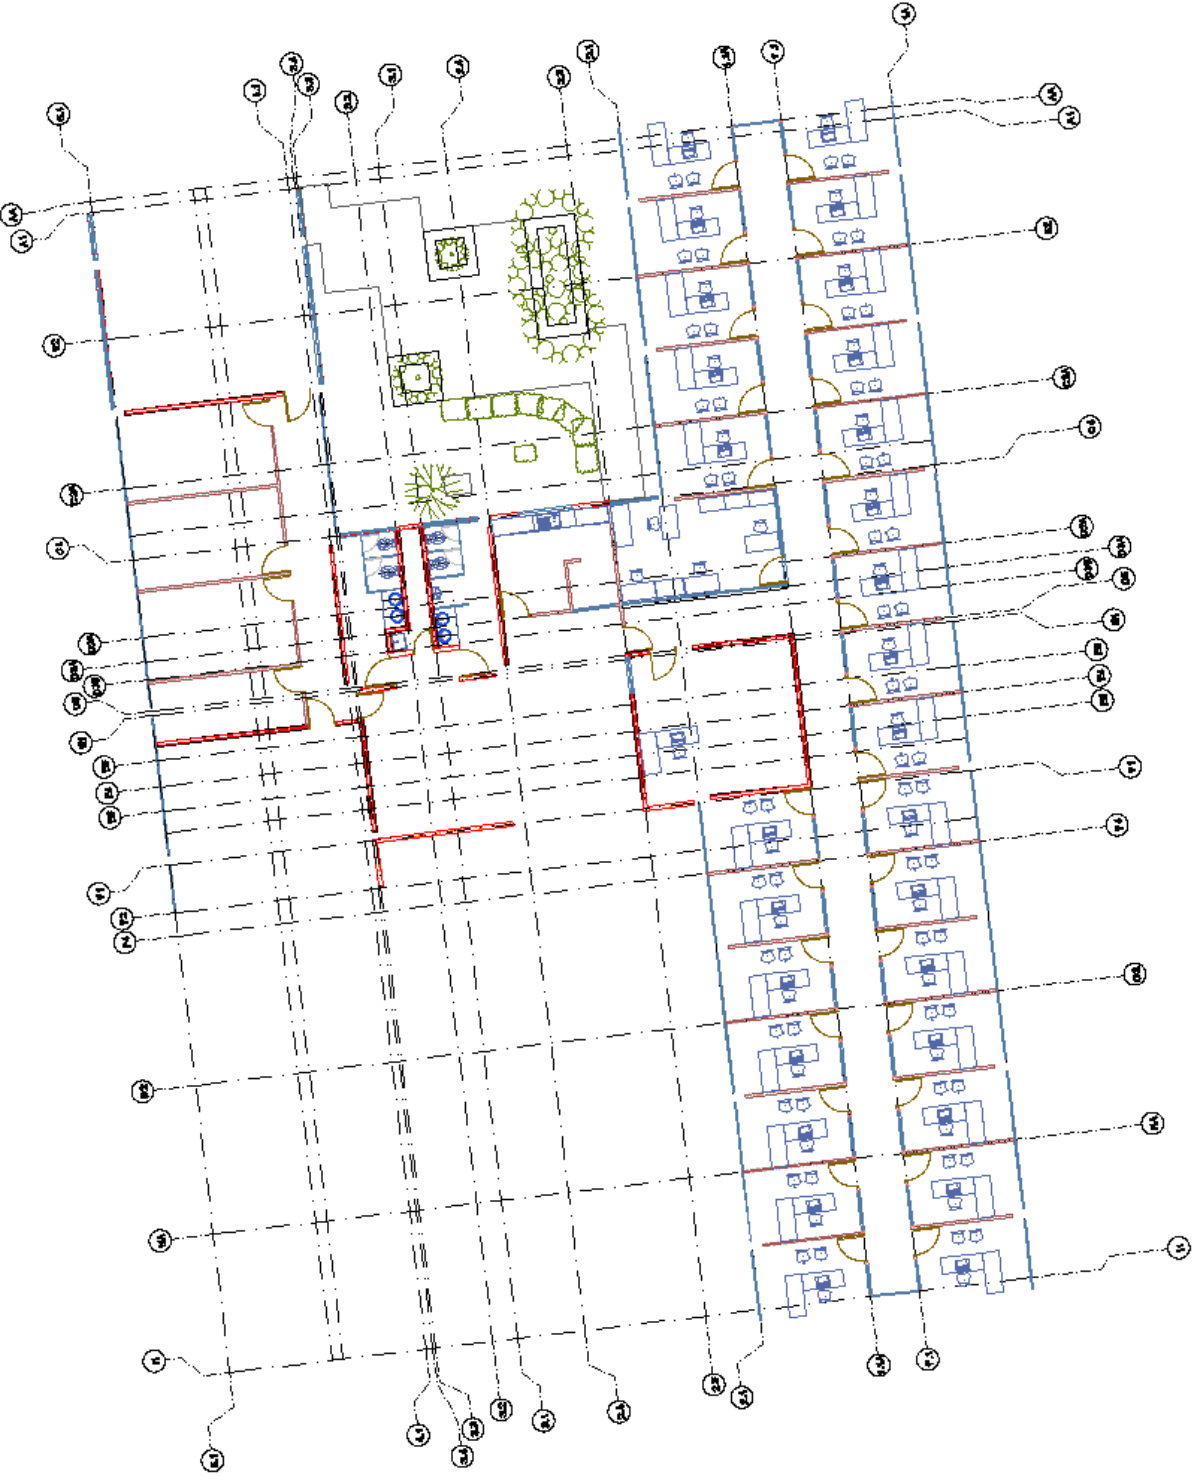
Planta de Conjunto del Constructor Arquitectónico de la Planta Baja estado Original
